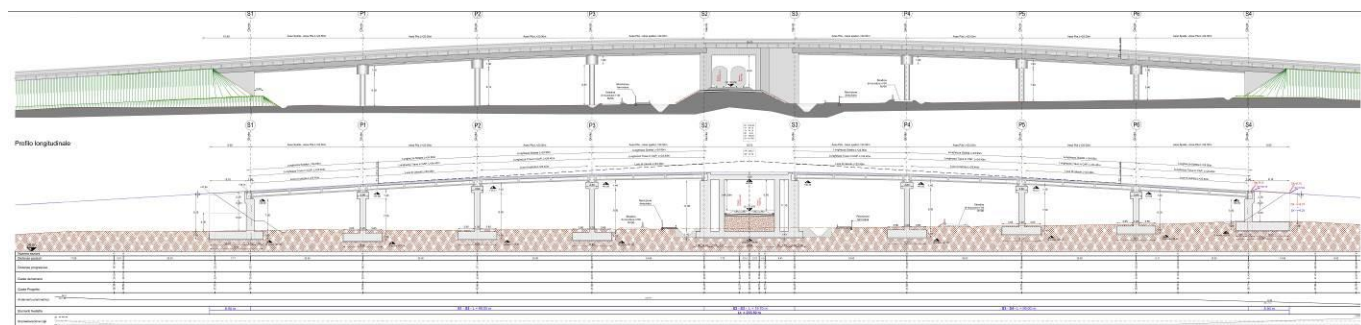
Prospetto e profilo longitudinale cavalcaferrovia "Rafaschieri"
